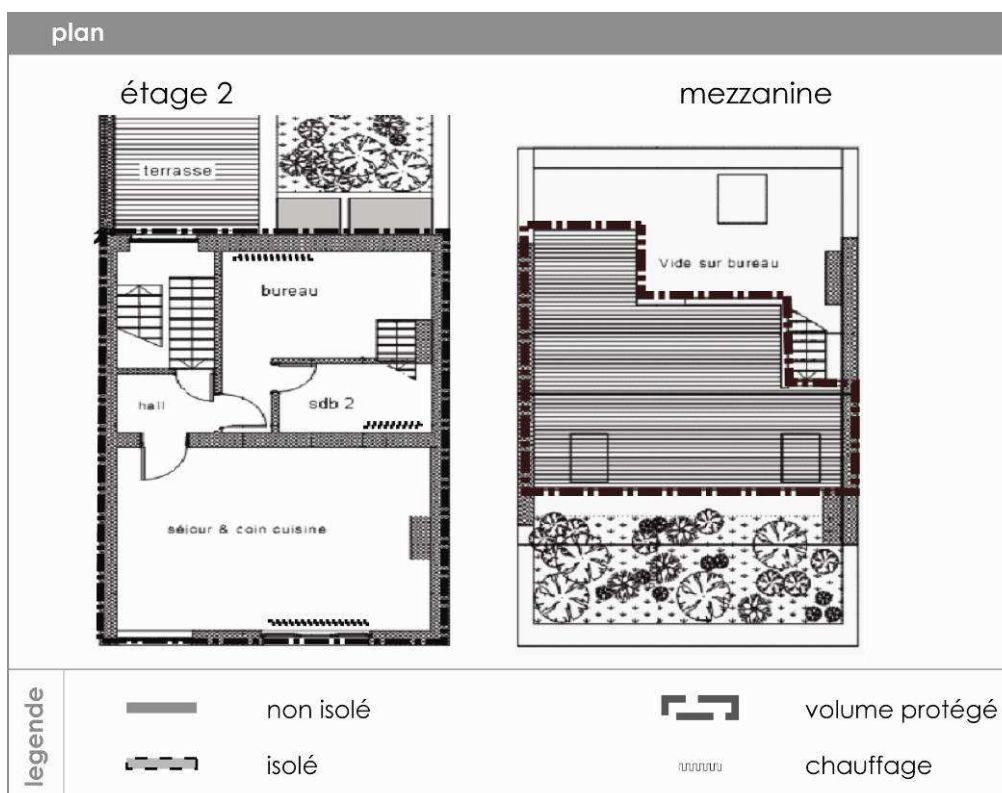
Plan au sol d'une maison de maître, avec de gauche à droite : deuxième étage et mezzanine
